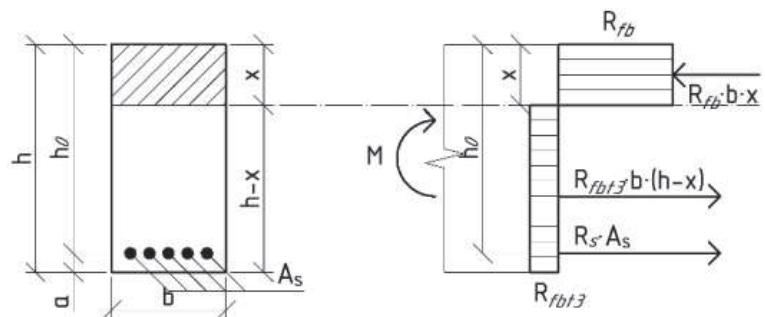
Схема усилий и эпюра напряжений в сечении, нормальном к продольной оси изгибаемого сталефибробетонного элемента прямоугольного профиля с продольной растянутой арматурой при его расчете по прочности по СП 360.1325800.2017
